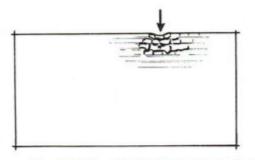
FISURAS EN LOS MUROS DE OBRA DE FABRICA
